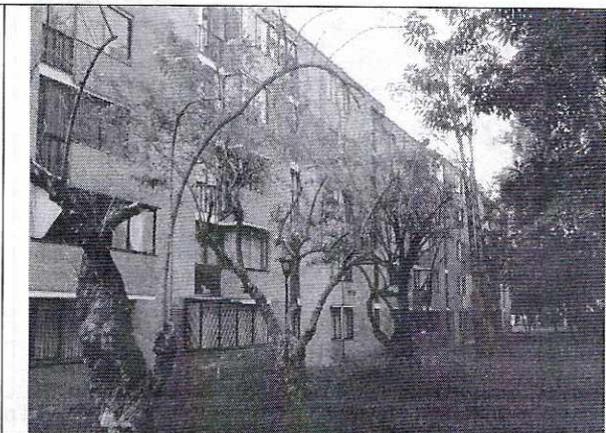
Fachada costado nororiental. Colinda con zona verde y arbolado
